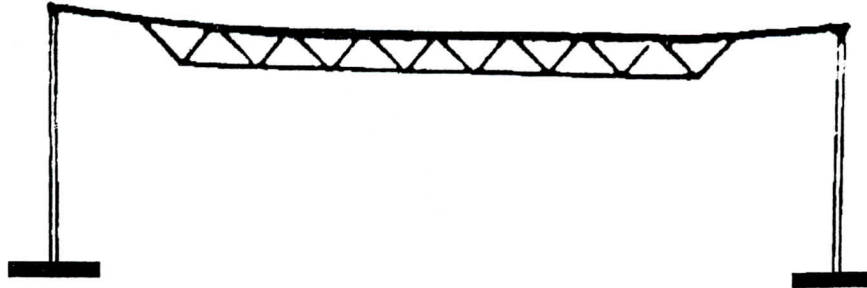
Effondrement d'un plancher au cours de coulage [3]
